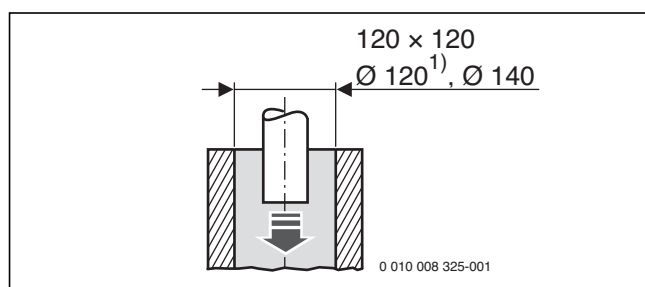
Mindestmaße des Schachtquerschnitts für die Montage der Abgasleitung (Maße in mm)
